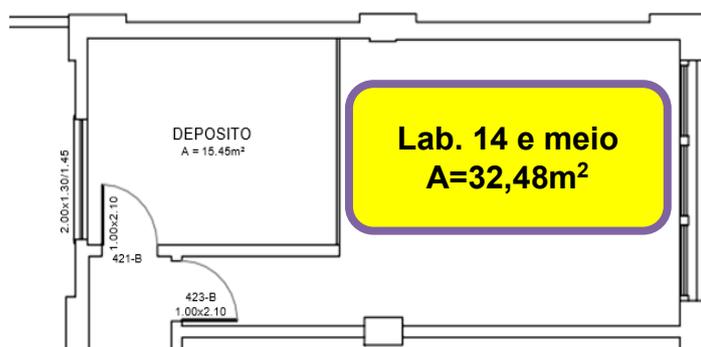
Planta-baixa do bloco 4 - 2º pavilhão
